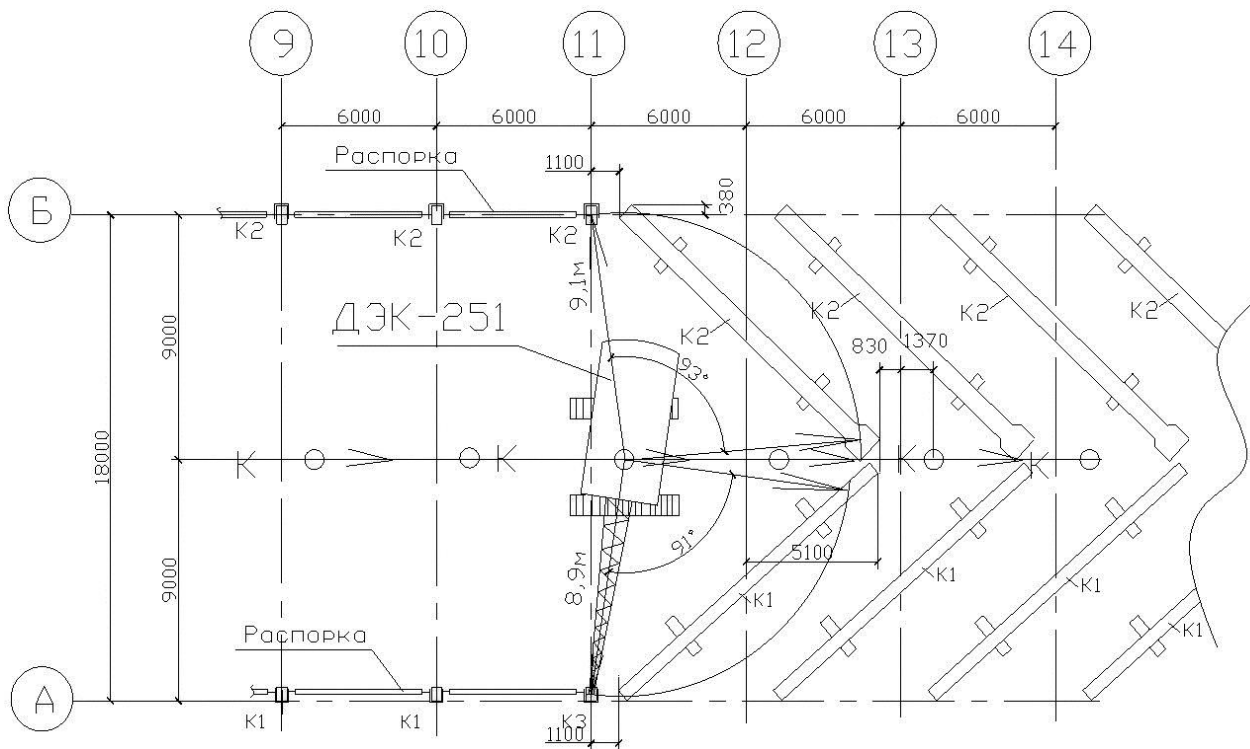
Схема монтажа колонн способом поворота со смещением стоянки относительно поперечной оси вперед по ходу крана
